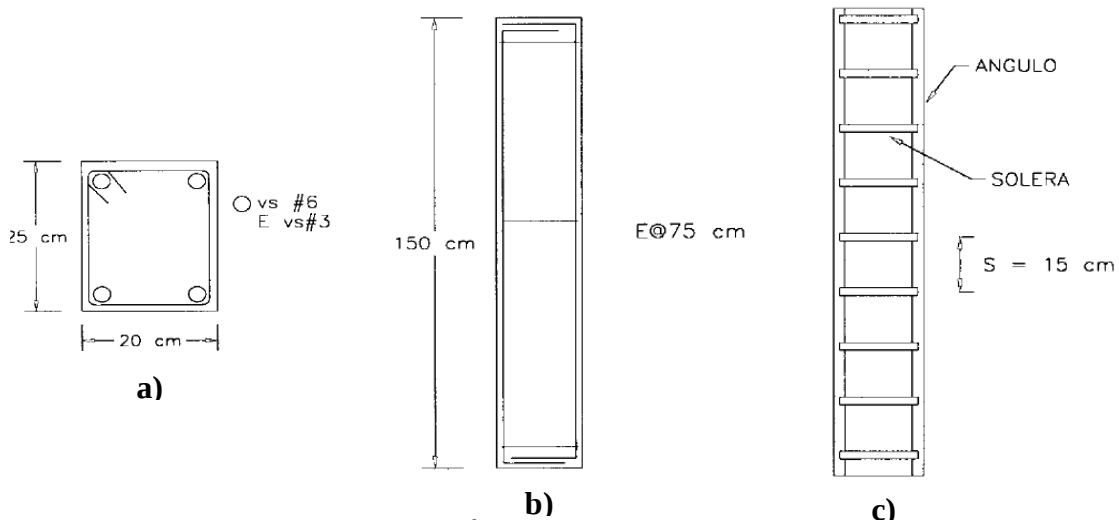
Elemento tipo; a) sección de la columna, b) elemento original y c) elemento encamisado, adaptado de González Cuevas (2007).
